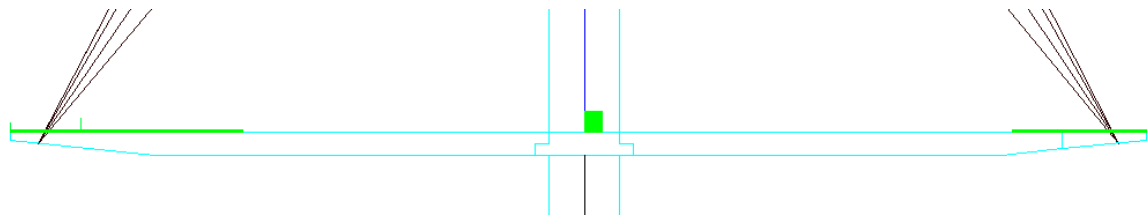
Sección del tablero, corte b'-b puente 4 sur
